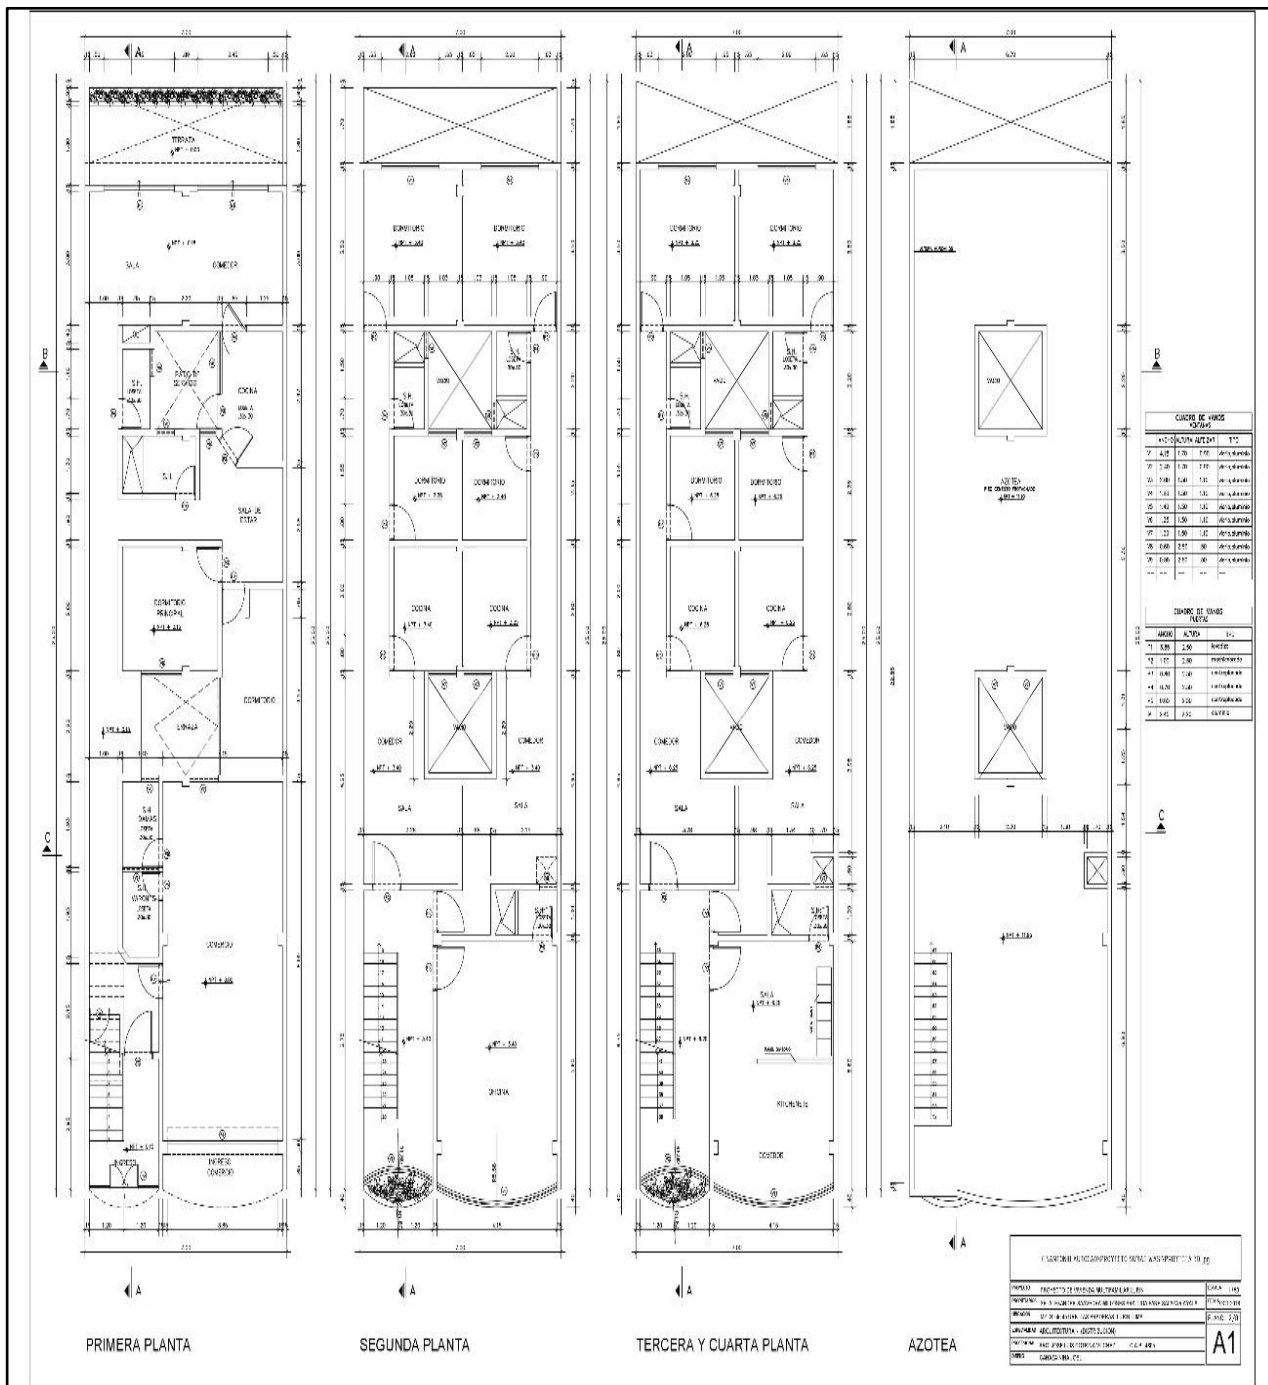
Esquema de arquitectura, vista en planta (Fuente Arq.Diego Moreno)
